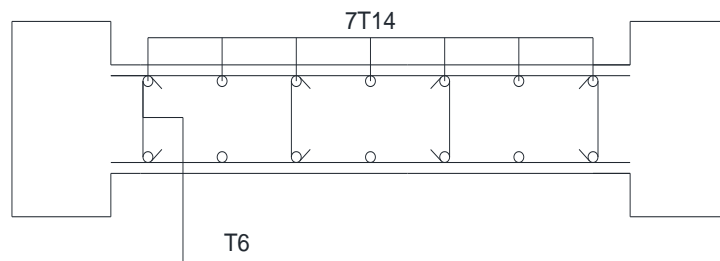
Schéma de ferrailage du voile (poutres normales - plan légèrement irrégulier)
